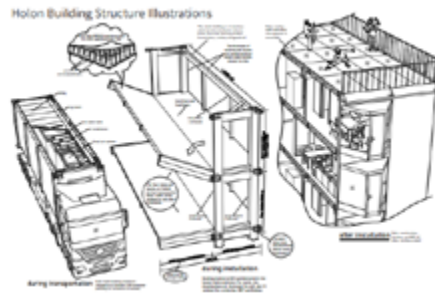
Modulo prefabricado. Fuente: Broad (2023).
